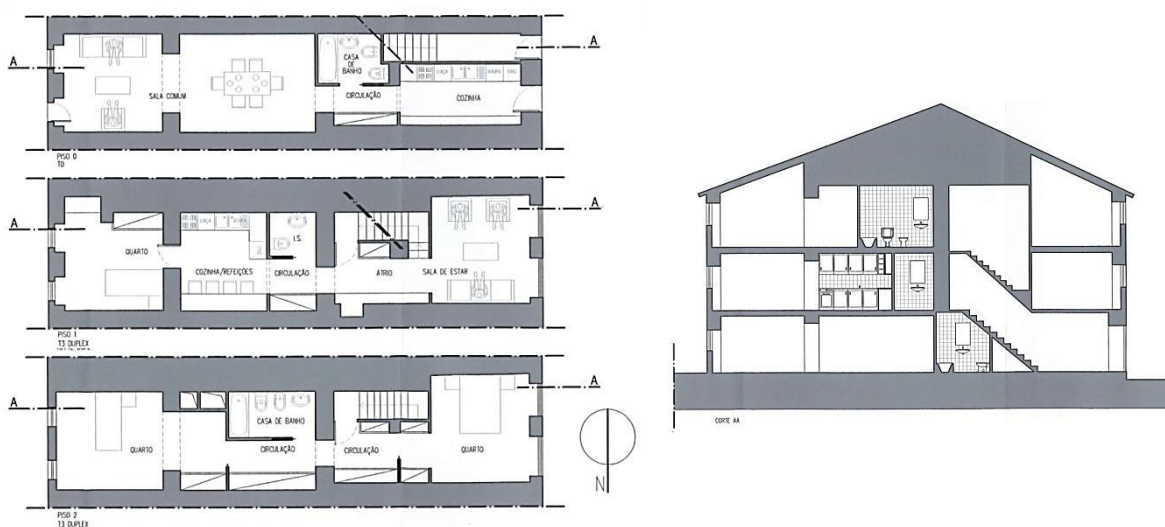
Desenhos técnicos (solução 3 - proposta) - plantas/corte
